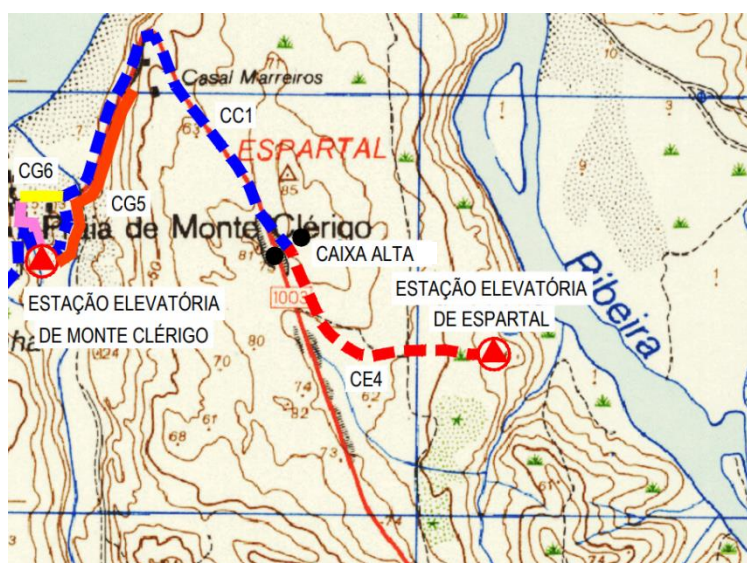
Excerto da Planta Geral de Localização do Projeto de Execução do Sistema intercetor do Espartal
